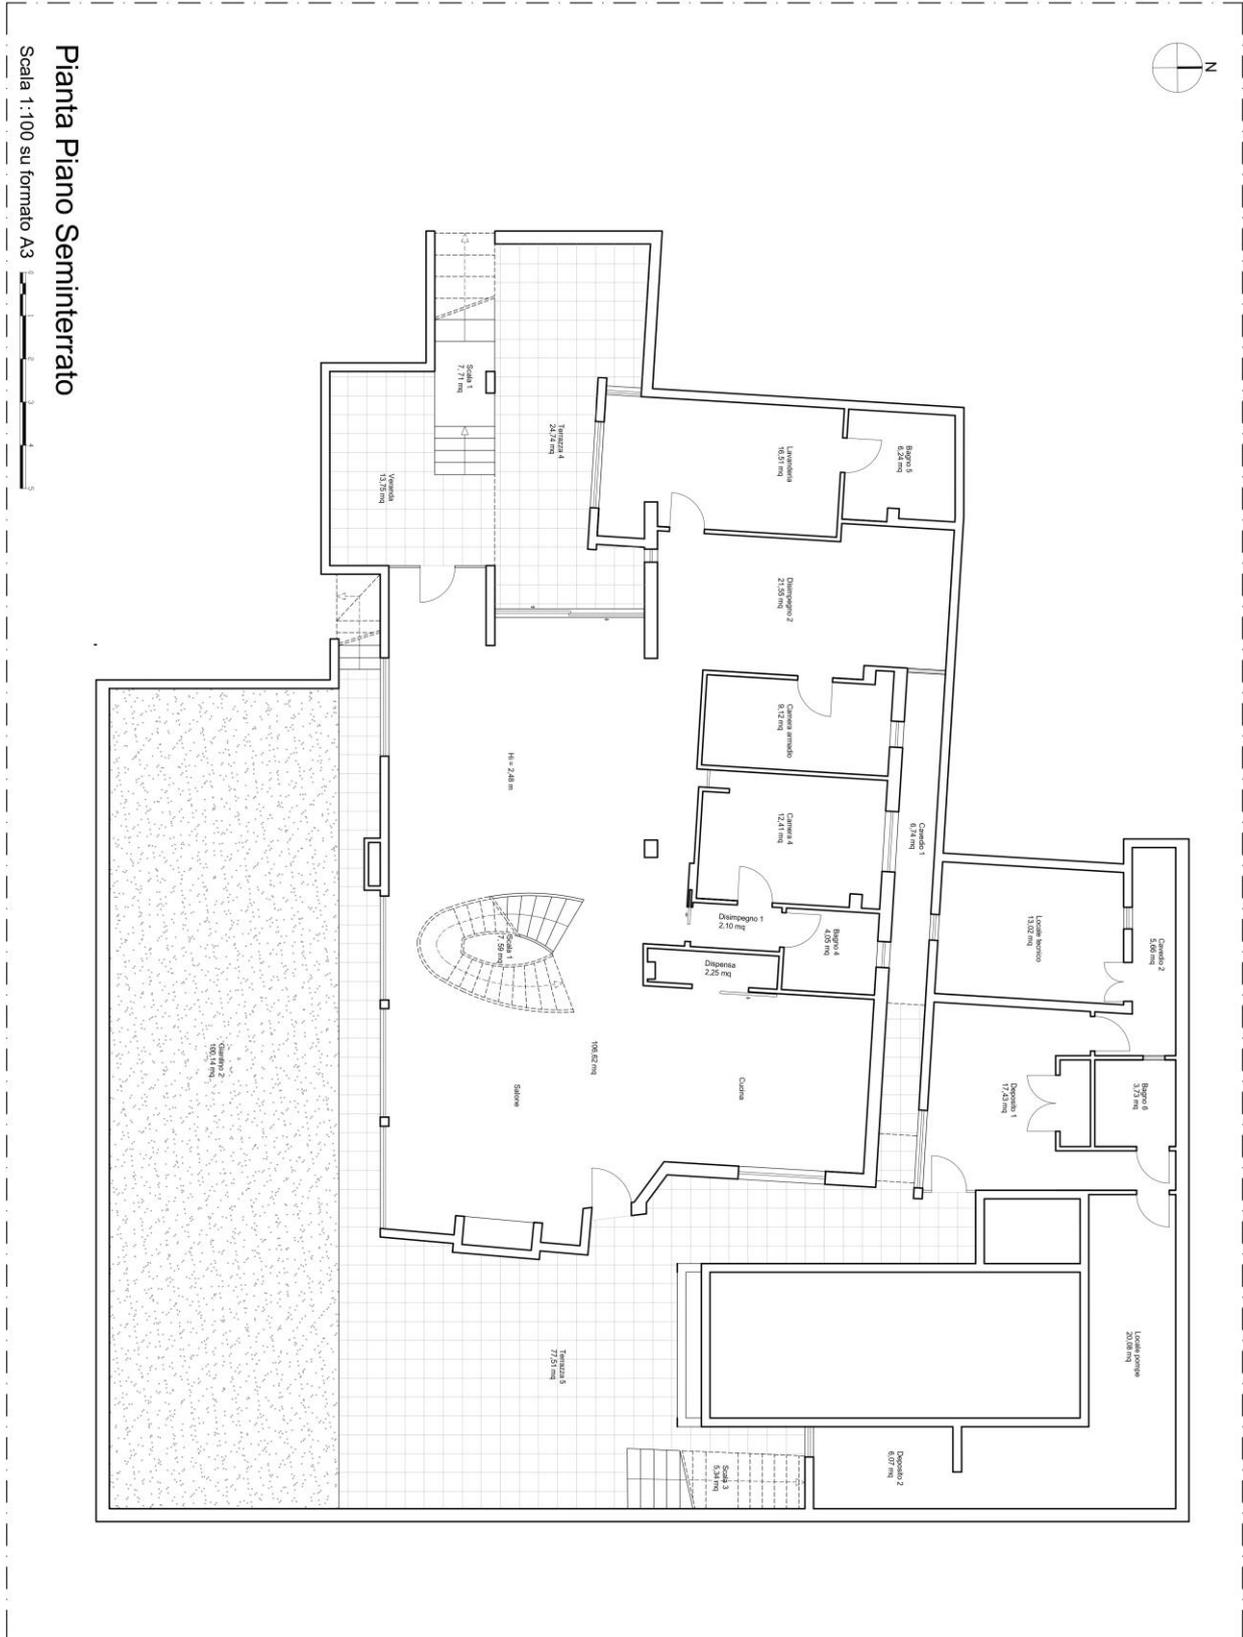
Planimetria dello stato di fatto – pianta piano seminterrato
